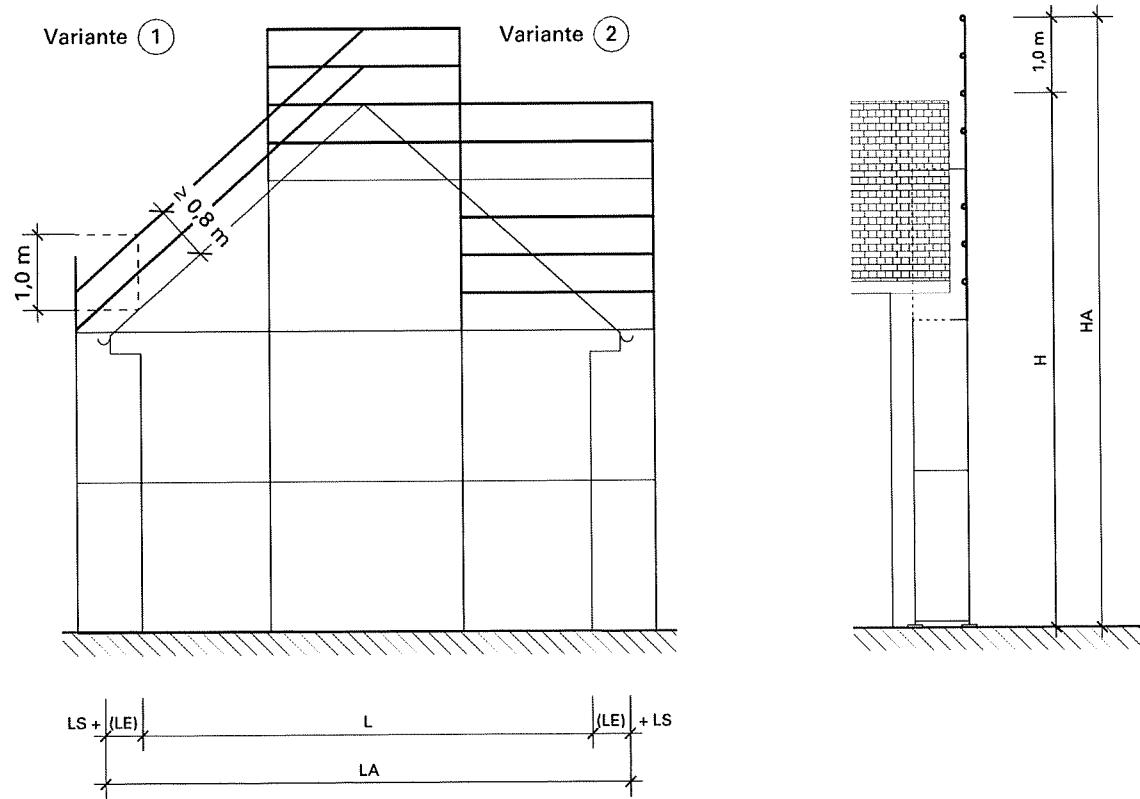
Dachdeckerschutzwand bei Dachneigungen über 25°
